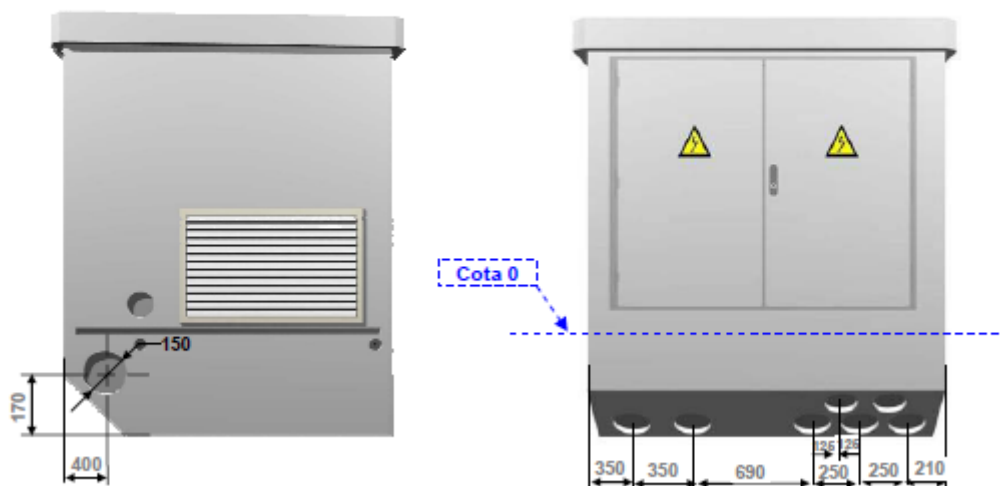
Dimensiones de los accesos de cable de MT / BT
